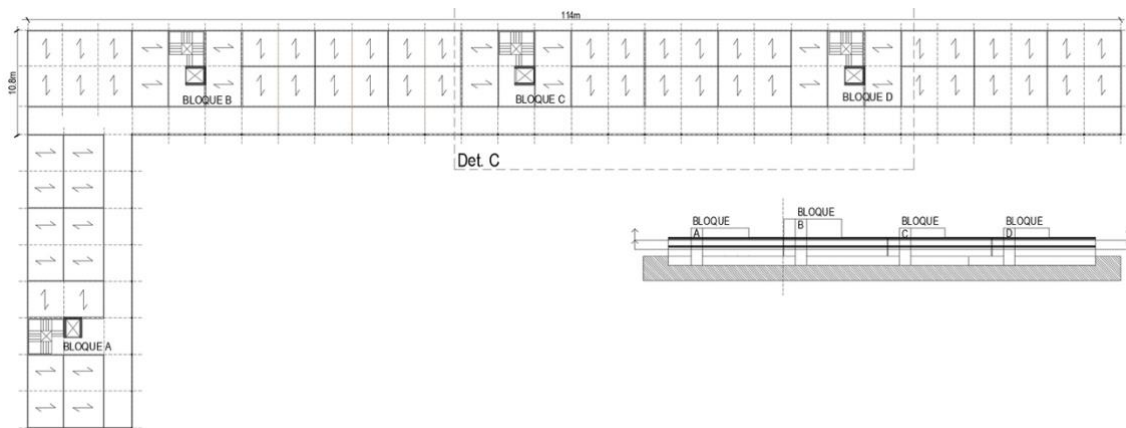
Planta tipo de estructura de madera. Techo de planta primera.
